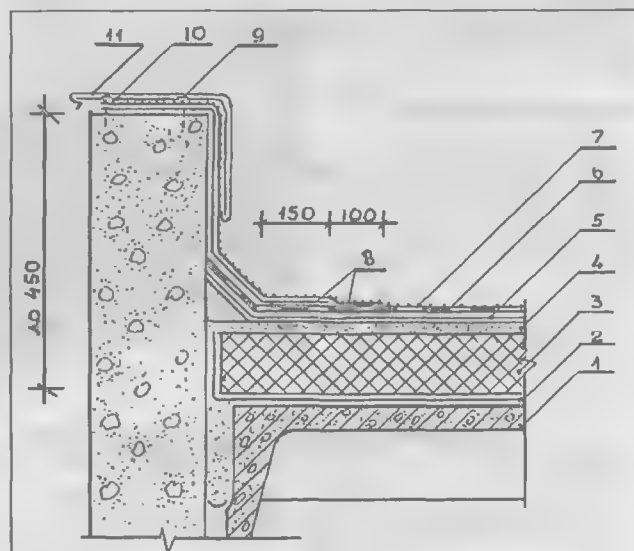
Примыкание кровли к парапету высотой до 450 м:
